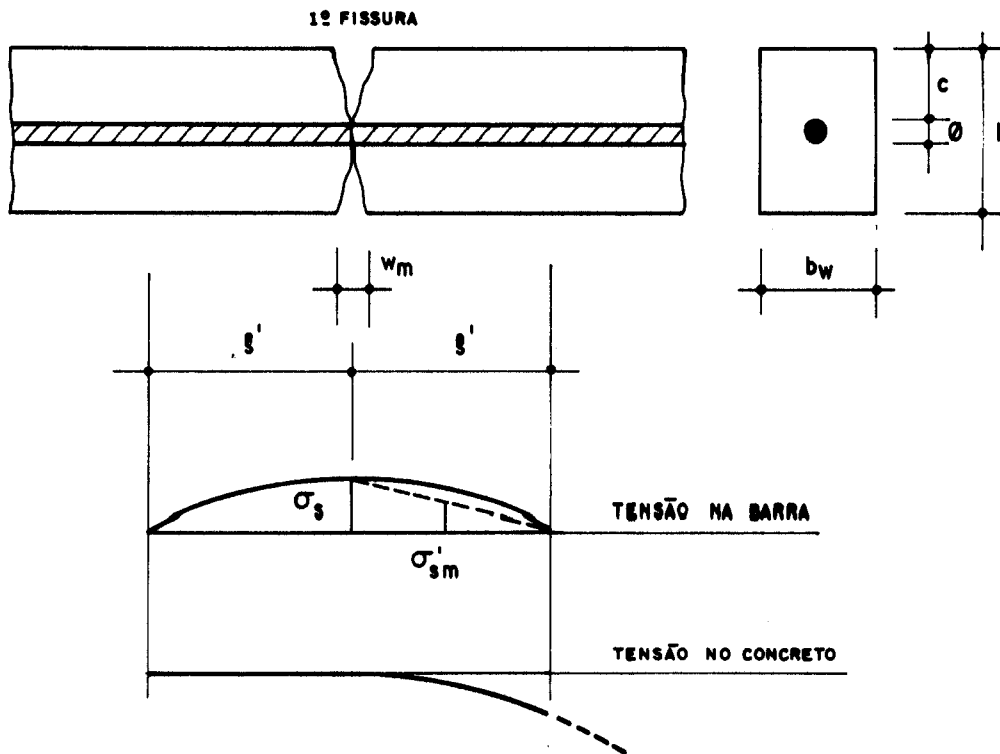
FISSURAÇÃO ASSISTEMÁTICA - MOLLIÇA JUNIOR⁵³
